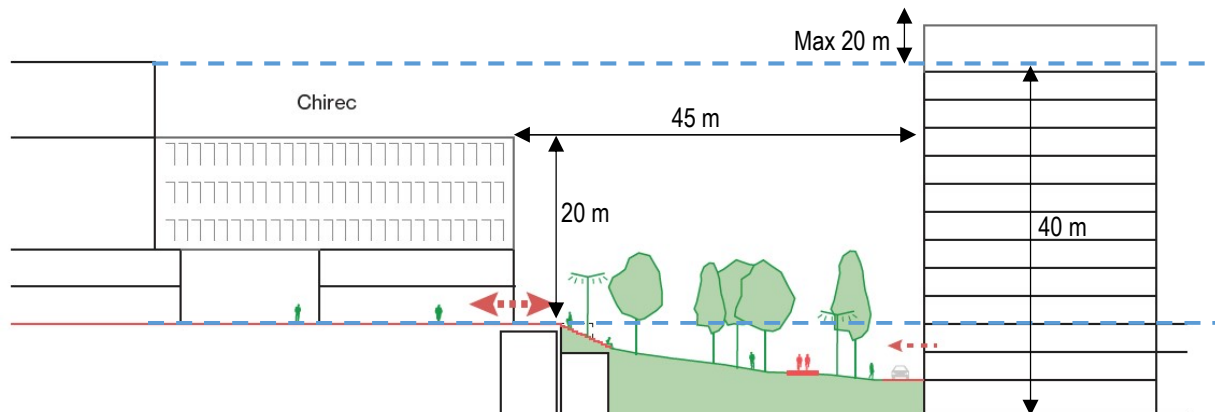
Profil du parkway du site Triangle (ARIES sur fond ORG², 2018)
